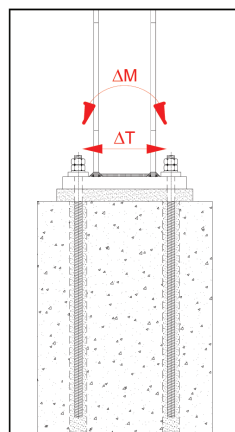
Collegamento classico di un montante di una barriera antirumore sull'opera d'arte, ad esempio su cordolo di viadotto o su fondazione in rilevato. *Typical connection of a noise protection barrier column on the manifold, for example on the viaduct riddle or on embankment foundation.
